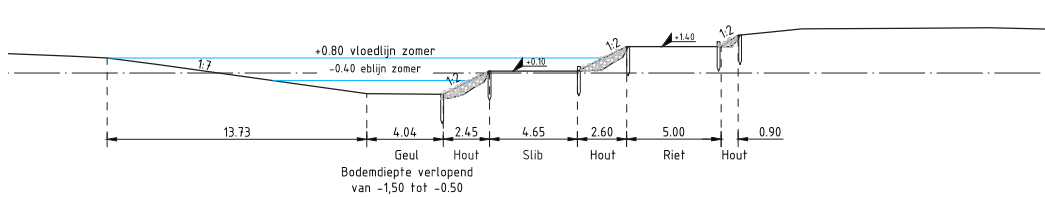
Doorsnede getrapte oever noordzijde.
